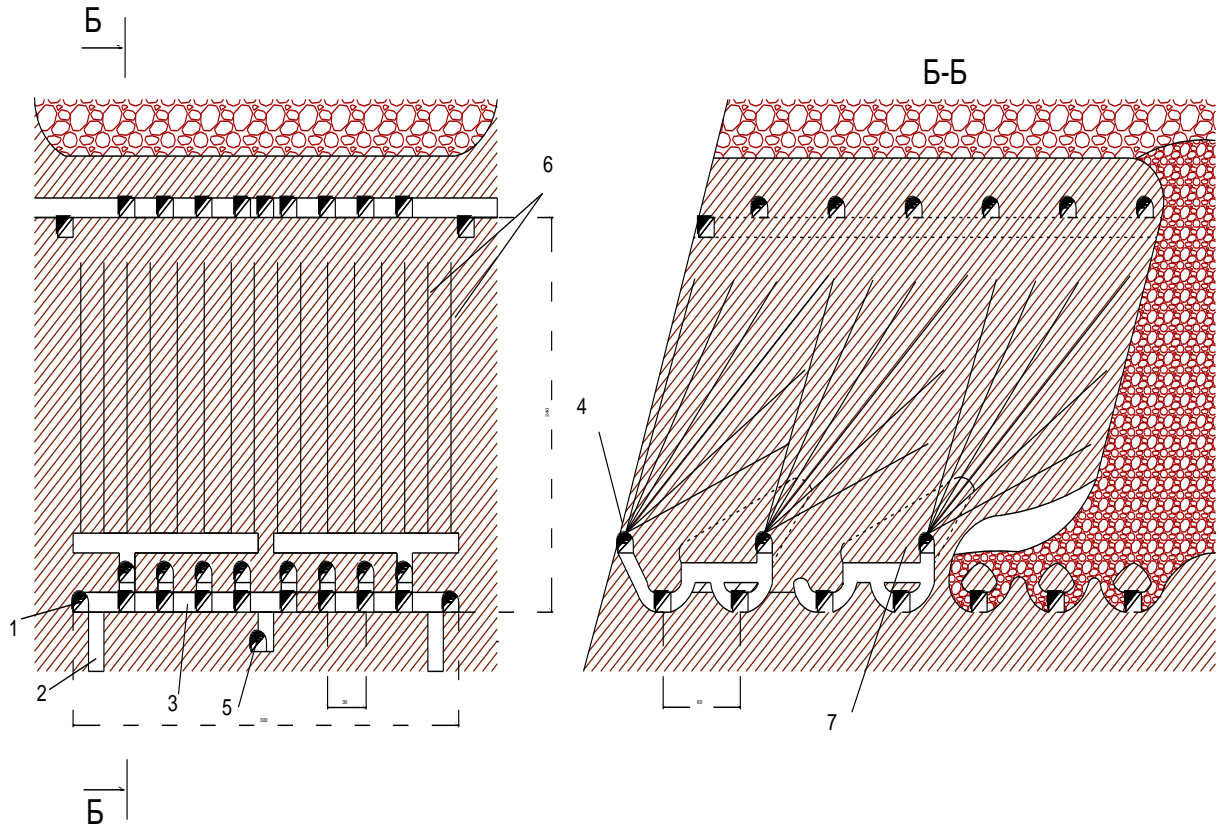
Подэтажное обрушение с донным выпуском руды со сплошной выемкой и отбойкой наклонными слоями: 1 - орт подэтажный, 2 - рудоспуск, 3 - штрек скреперования, 4 - буровой орт (штрек), 5 - вентиляционный орт, 6 - "веера" скважин, 7 - подсечное пространство.
